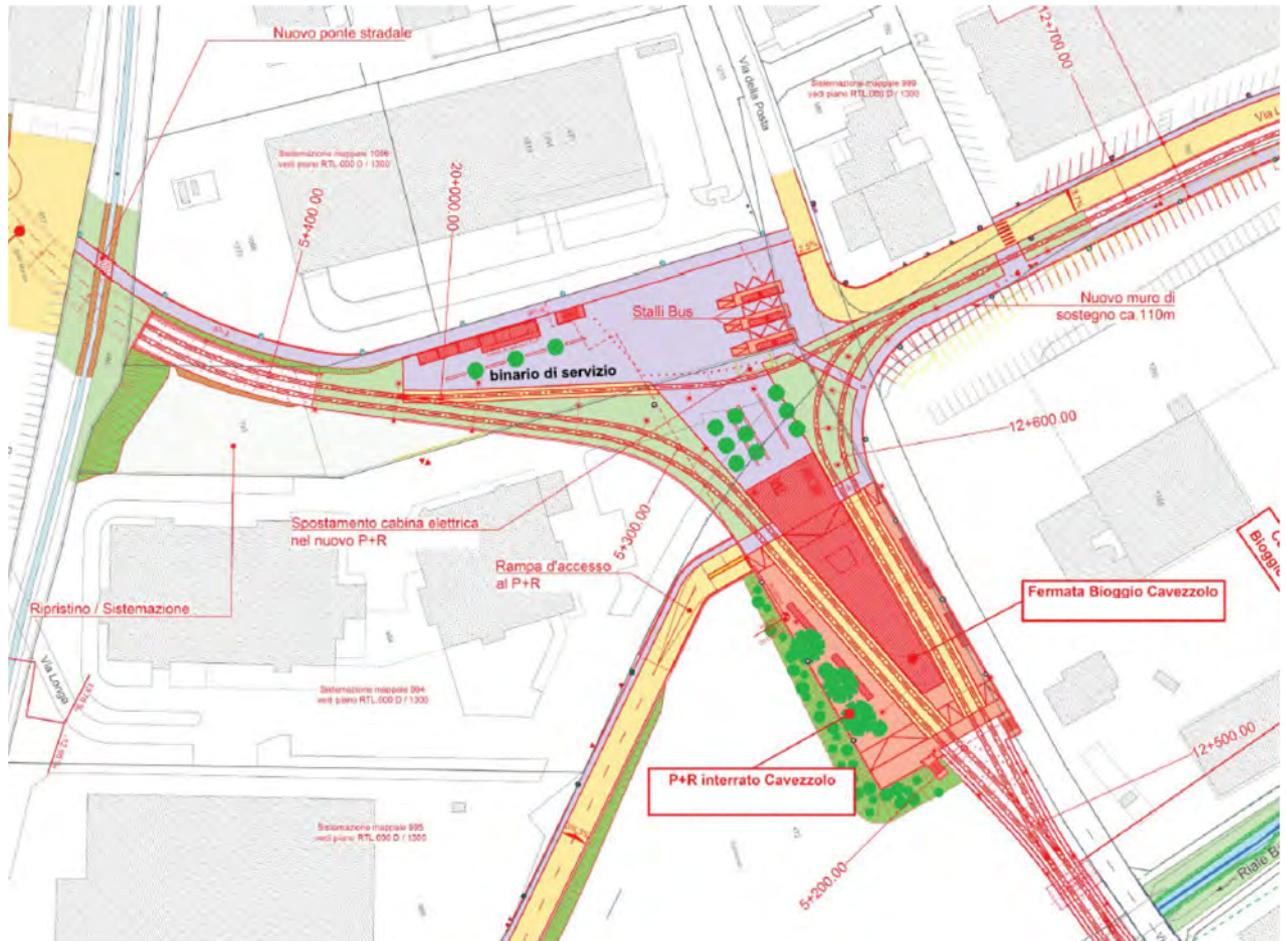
Planimetria del nodo di Bioggio Cavezzolo nel progetto 2020 approvato.
